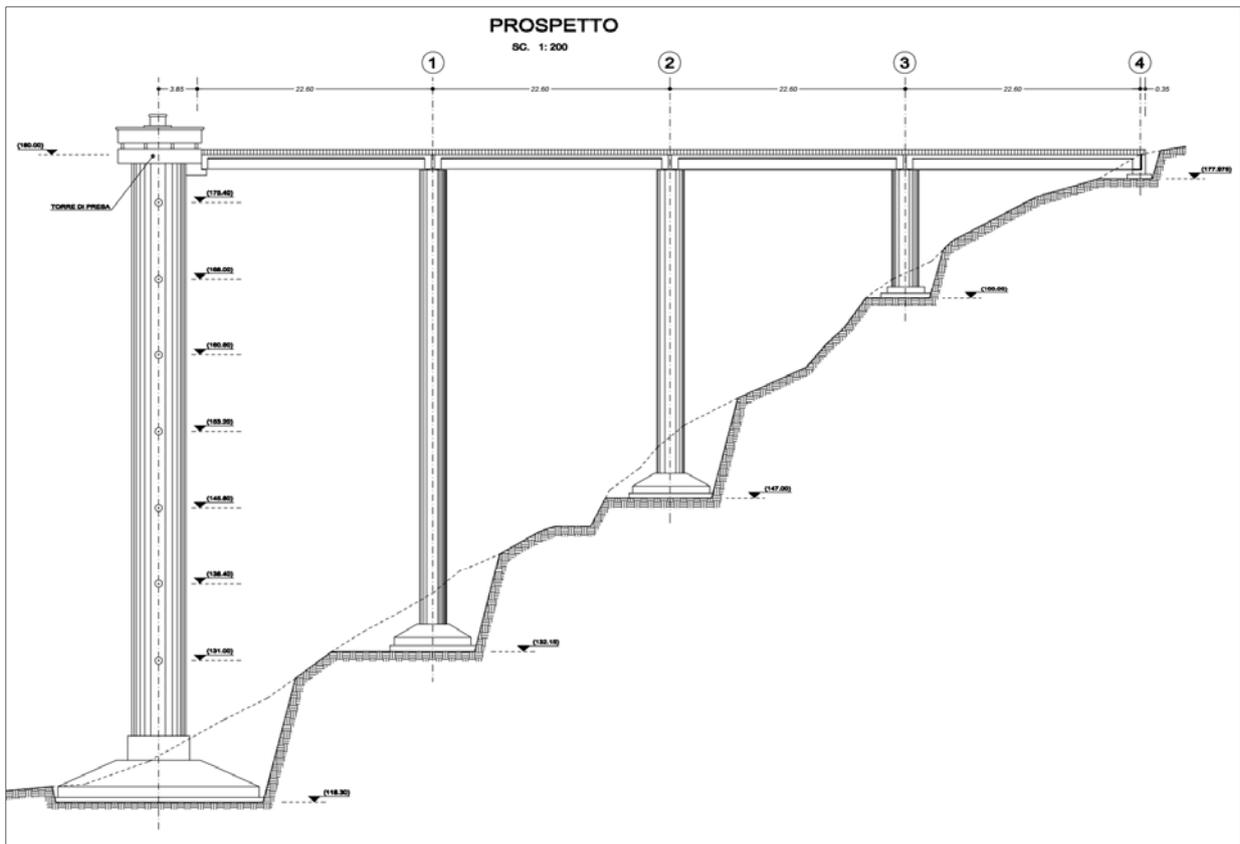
Torre di presa del Liscia – Prospetto torre e passerella di accesso
